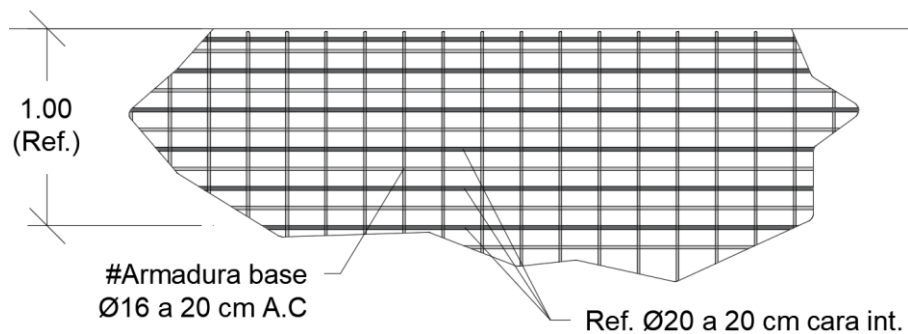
Refuerzo sobre armadura base en Muro Externos 4 y 7 (armadura horizontal)
